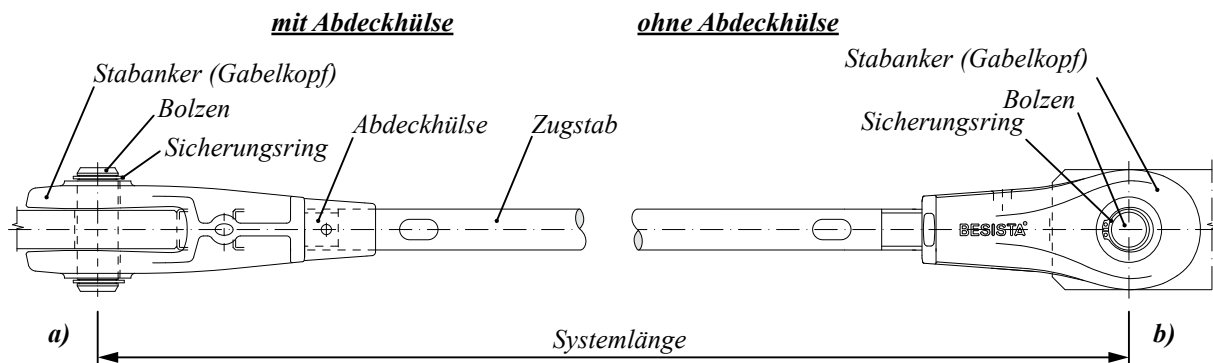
BESISTA® Stabsysteme – Hauptkomponenten. a) Draufsicht; b) Seitenansicht
